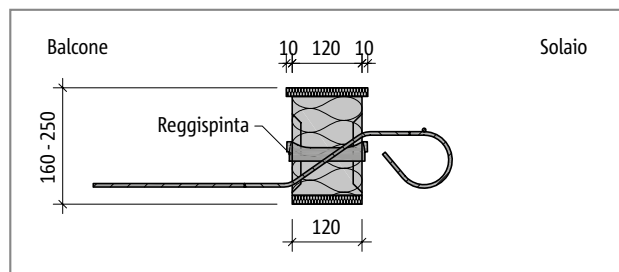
Schöck Isokorb® tipo da QXT10 a QXT40, REI120: sezione dell'elemento
